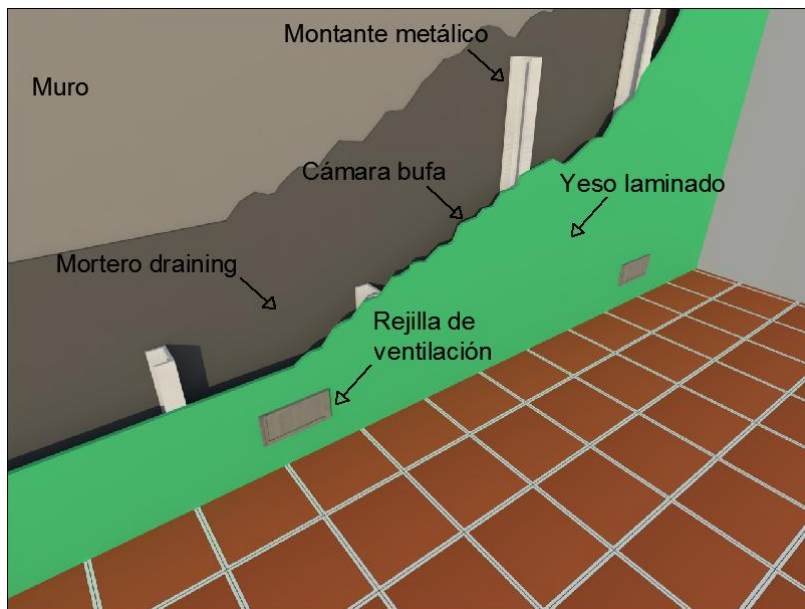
Detalle de la solución frente a la humedad en los muros de la vivienda de la planta baja. 2014. Elaboración propia.
